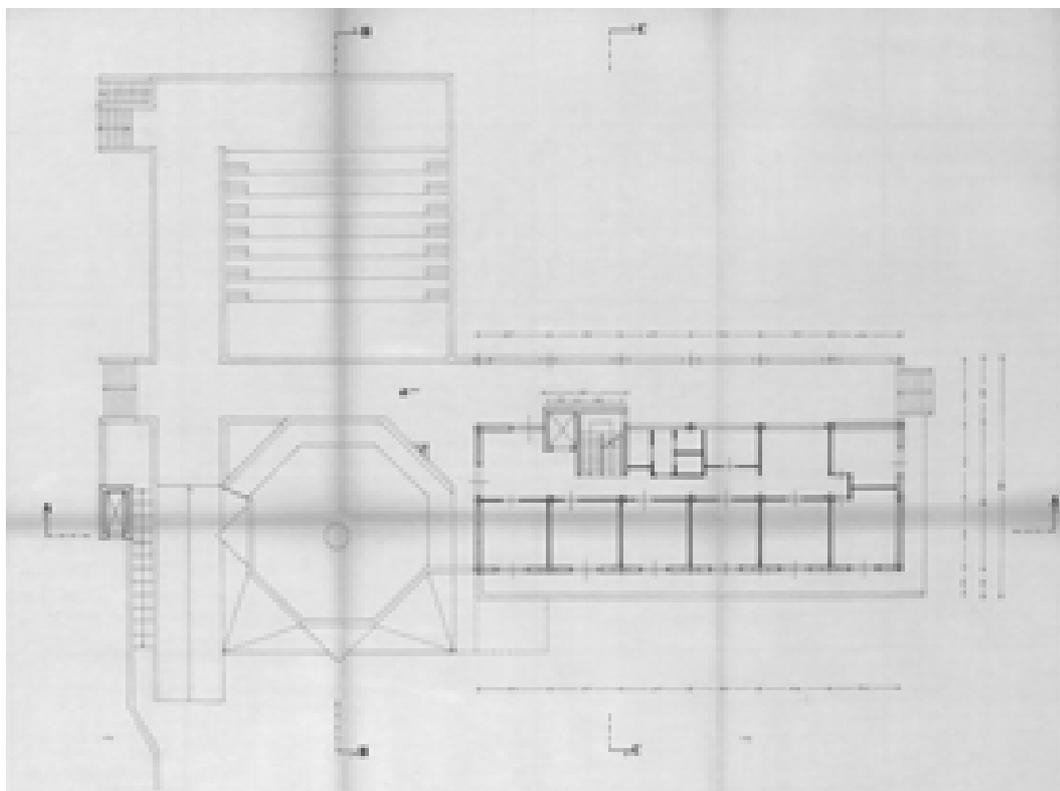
Pianta +1,00 – 02/08/1994 (AABS-64_650)
